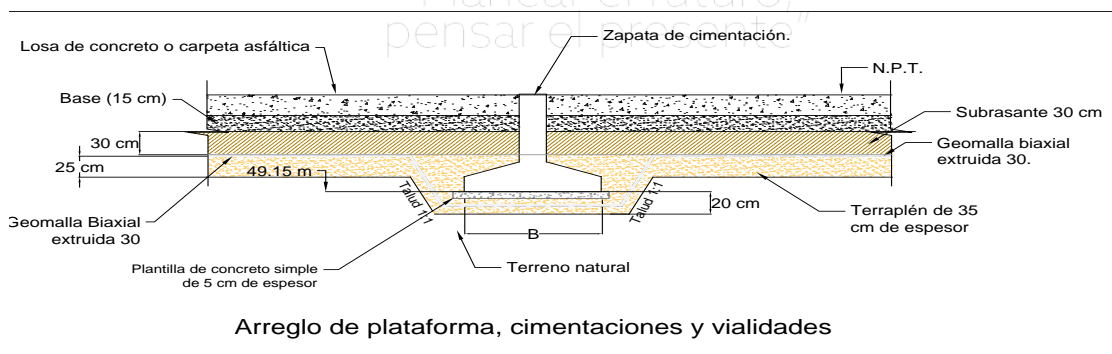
Solución de pavimentos y cimentación usando geomalla biaxial.
